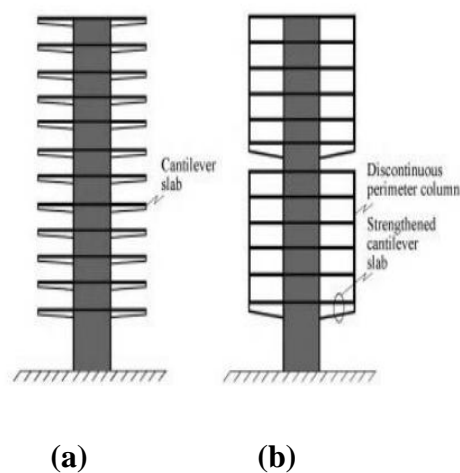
Dalles dans le système à noyau central(a) Dalle porte à faux, (b) dalles en console renforcées
